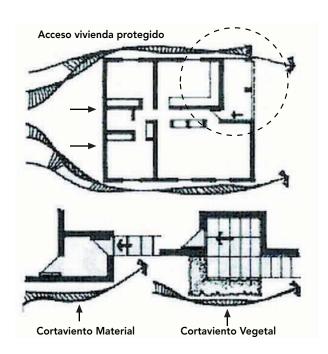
50: Ubicación y protección del acceso a la vivienda.
